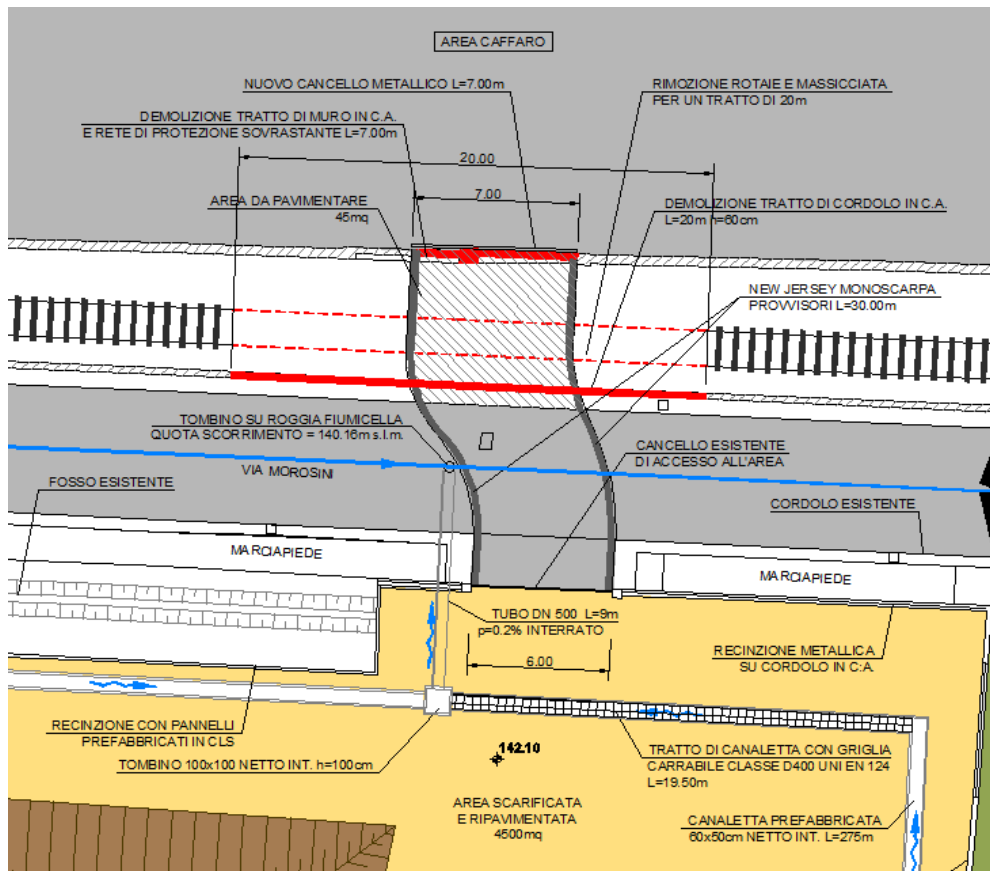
Piazzale di stoccaggio – Realizzazione pista di accesso da area “Caffaro”
